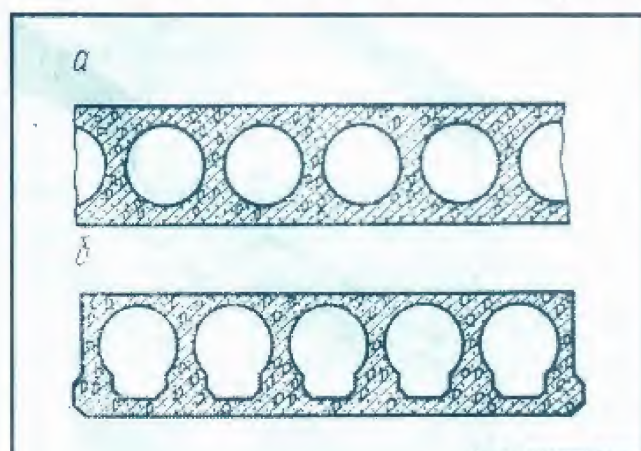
Збірні залізобетонні пустотілі настили з круглими (а) і з вертикальними (б) пустотами.
